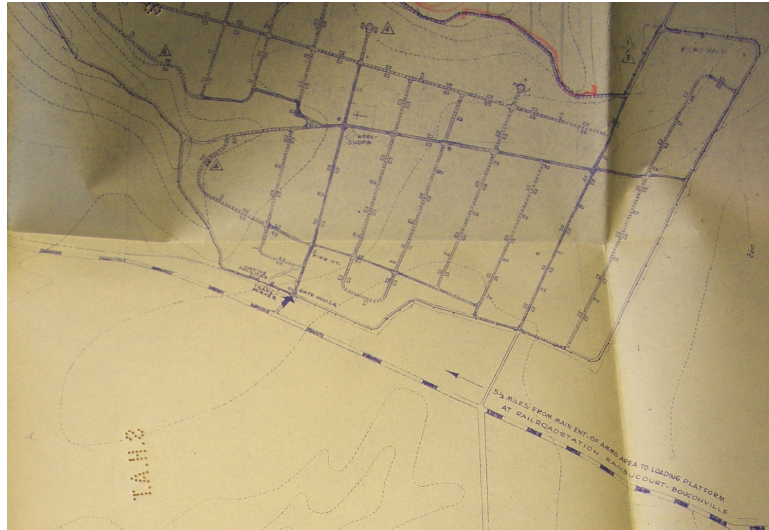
plan partiel de la zone de stockage de la forêt. SHD, 12 Q 162.
